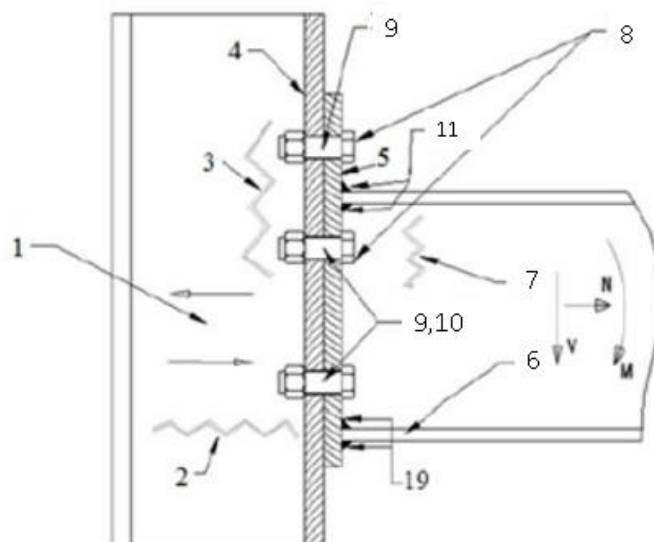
Componentes da ligação viga-pilar – Adaptado de MENDES (2017)
